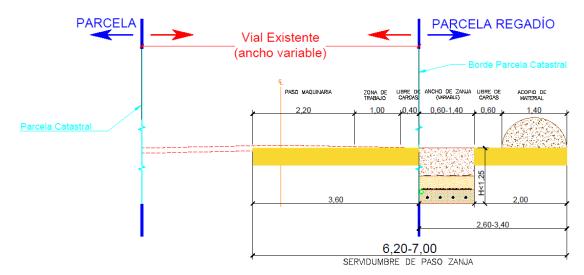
Zanja y servidumbre tipo en zonas de regadío
